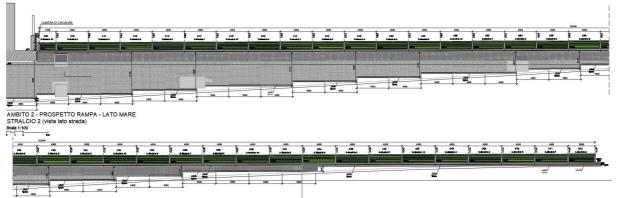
Prospetto della barriera dell'ambito 2 - lato mare
